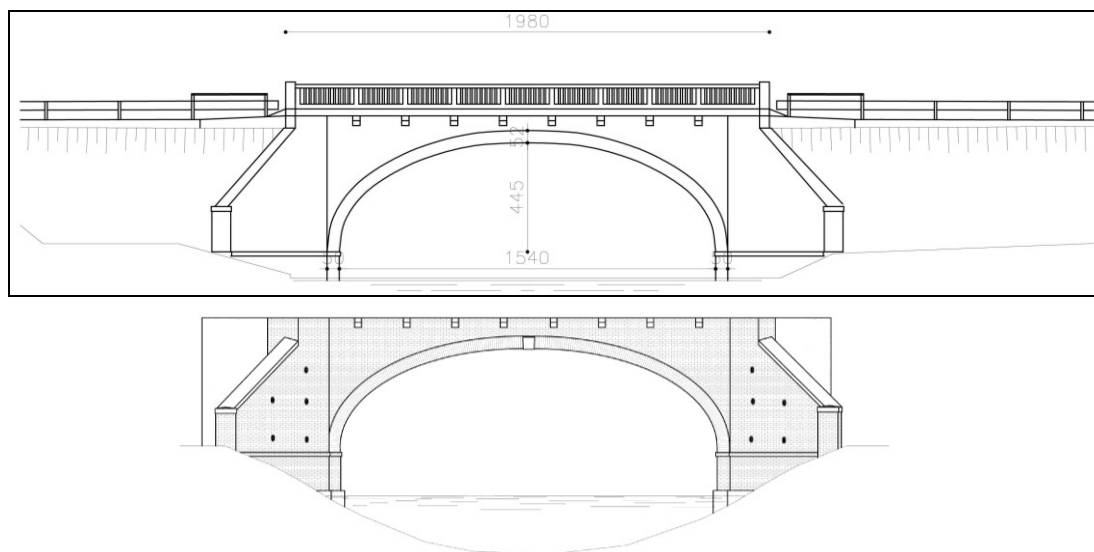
Prospetto nord del ponte. Vista quotata e vista solo muratura
